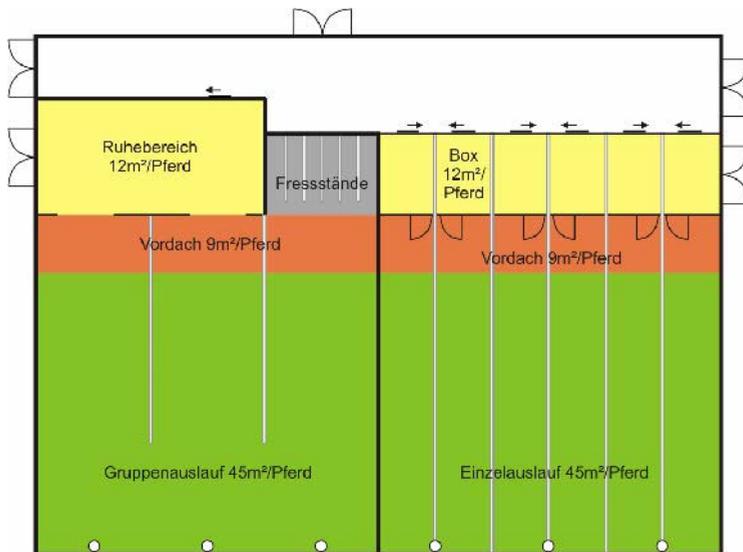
Grundriss der Versuchsanlage (Grafik: Kröckel)
